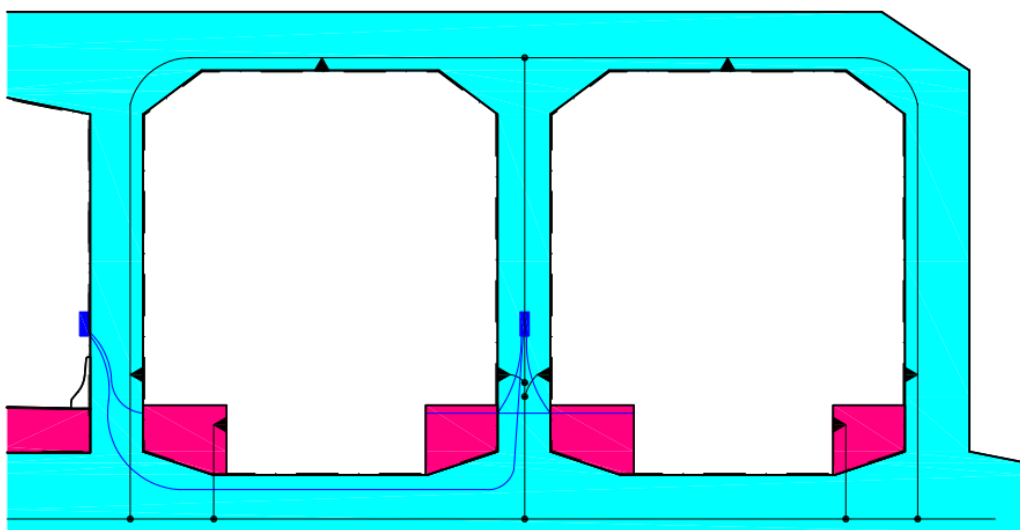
Beispiel für Einbindung der Tunnelbewehrung in eine gemeinsame Erdung
